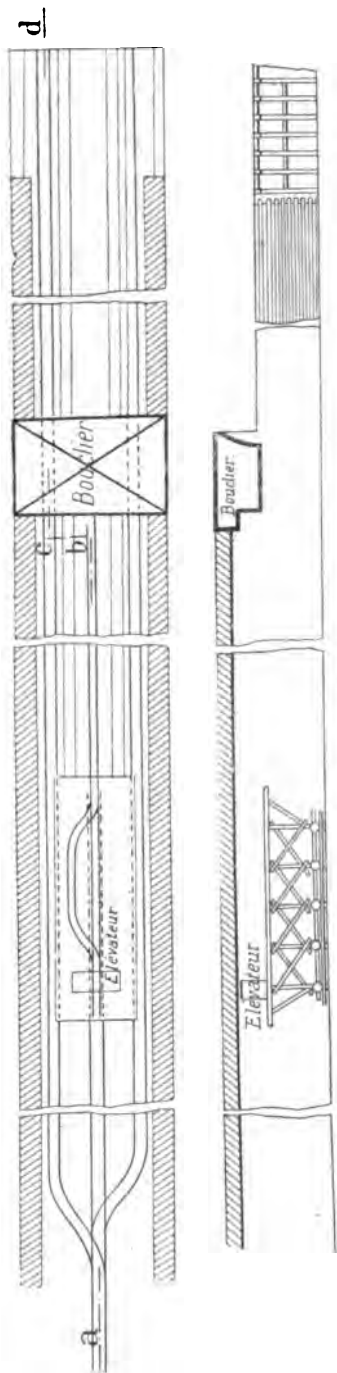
Organisation du chantier lors de l'exécution préalable des piédroits. Plan et coupe longitudinale.
